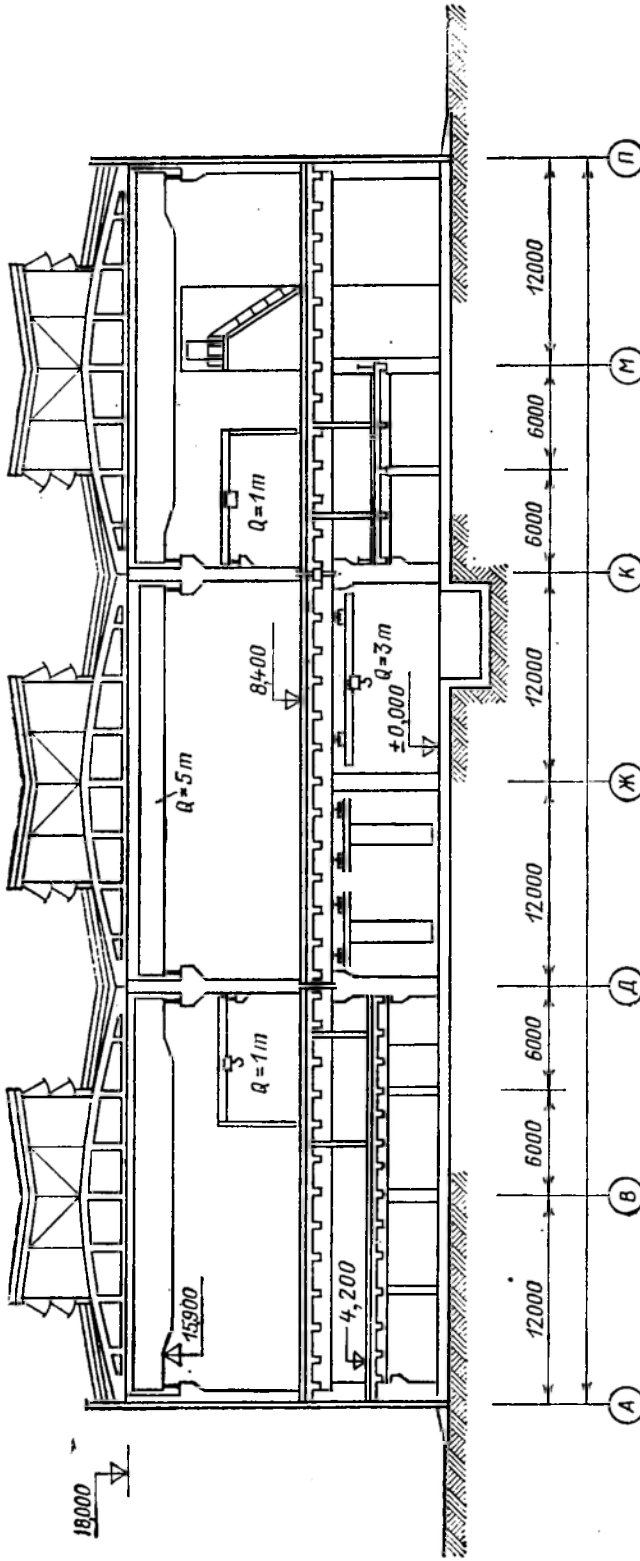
Разрез двухэтажного литейного цеха, выполненного из сборного железобетона. Пол второго этажа на отметке 8400 мм. Промежуточные площадки на отметке 4200 мм для размещения конвейеров охлаждения отливок. Здание перекрыто сборными железобетонными безраскосными фермами, на кровле светоаэрационные фонари
